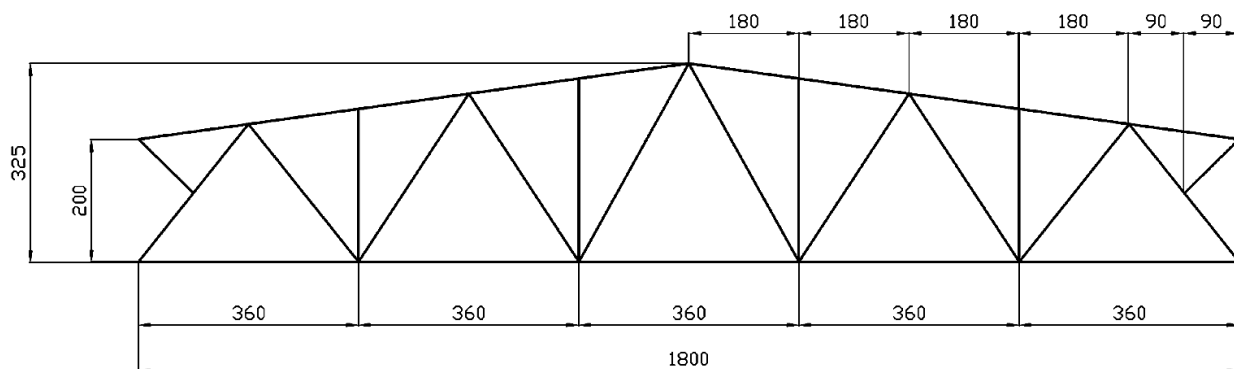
Размеры несущей фермы (в мм) модуля «Перекрытие здания».
